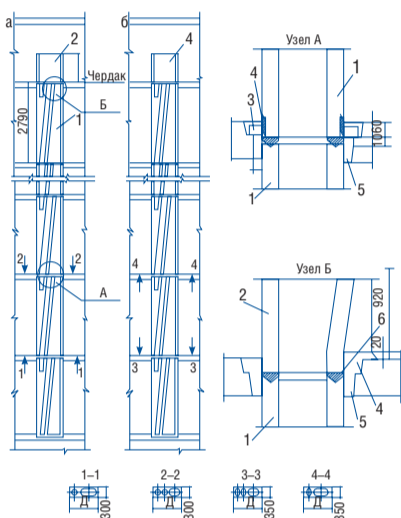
Устройства естественной вытяжной вентиляции в многоэтажных жилых домах: а – вентиляционные блоки санузлов; б – вентиляционные блоки кухонь; 1 – вентблок; 2 – оголовок вентблока; 3 – стальной опорный столик вентблока; 4 – цементный раствор; 5 – пакля, смоченная в растворе; 6 – упругая прокладка.
